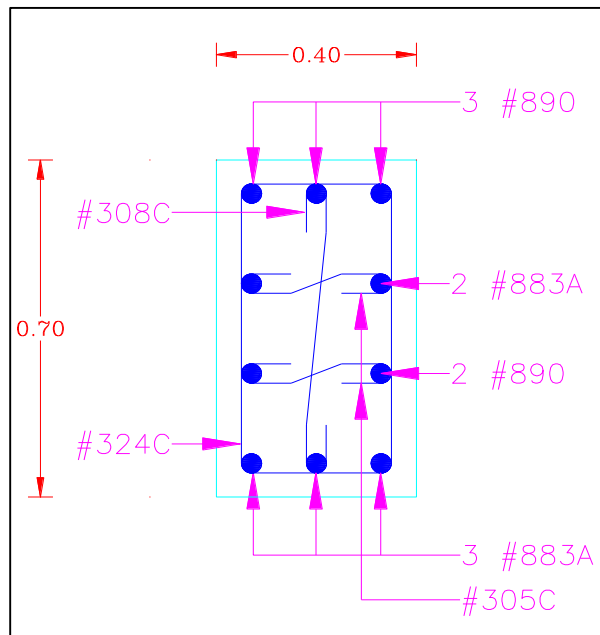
Detalle de refuerzo columna bloque de aulas.
